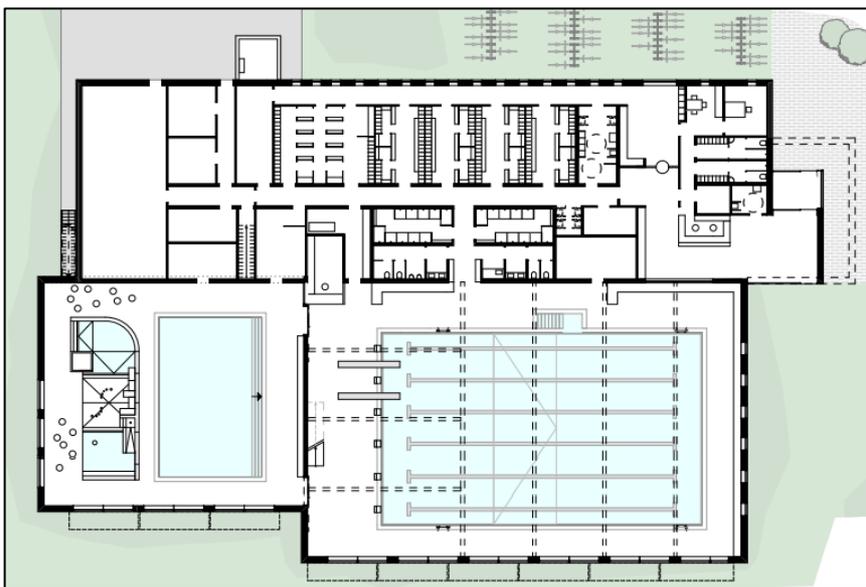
Planung des Hallenbadneubaus (Variante 2)
